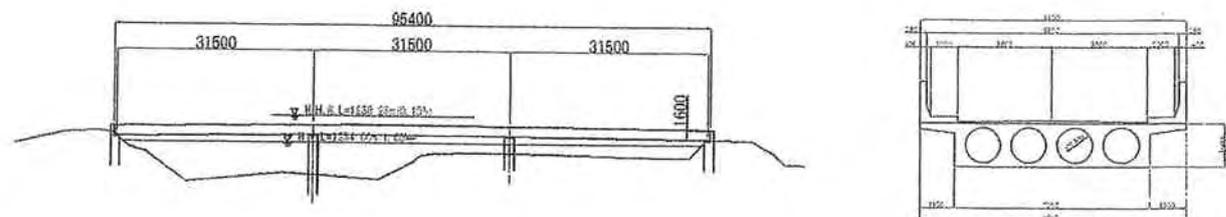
Plan du Pont dalles évidées continues en béton précontraint (longueur de travée : 31,5 m)
